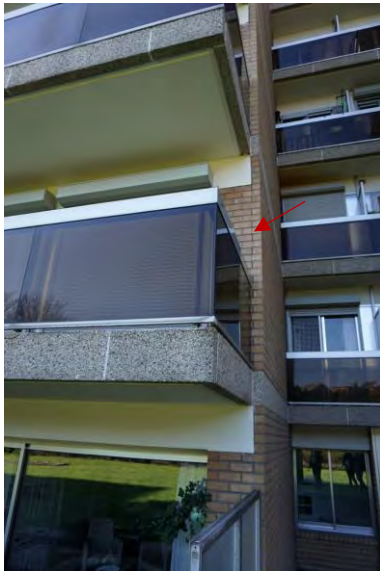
Betonschade aan balk boven raam keuken (vanwege bevestiging element tegen gevel?)
